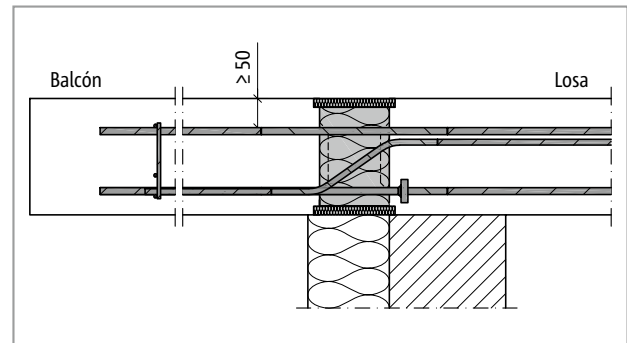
Schöck Isokorb® XT tipo C-CV50: Conexión para sistema de aislamiento térmico exterior (SATE)
